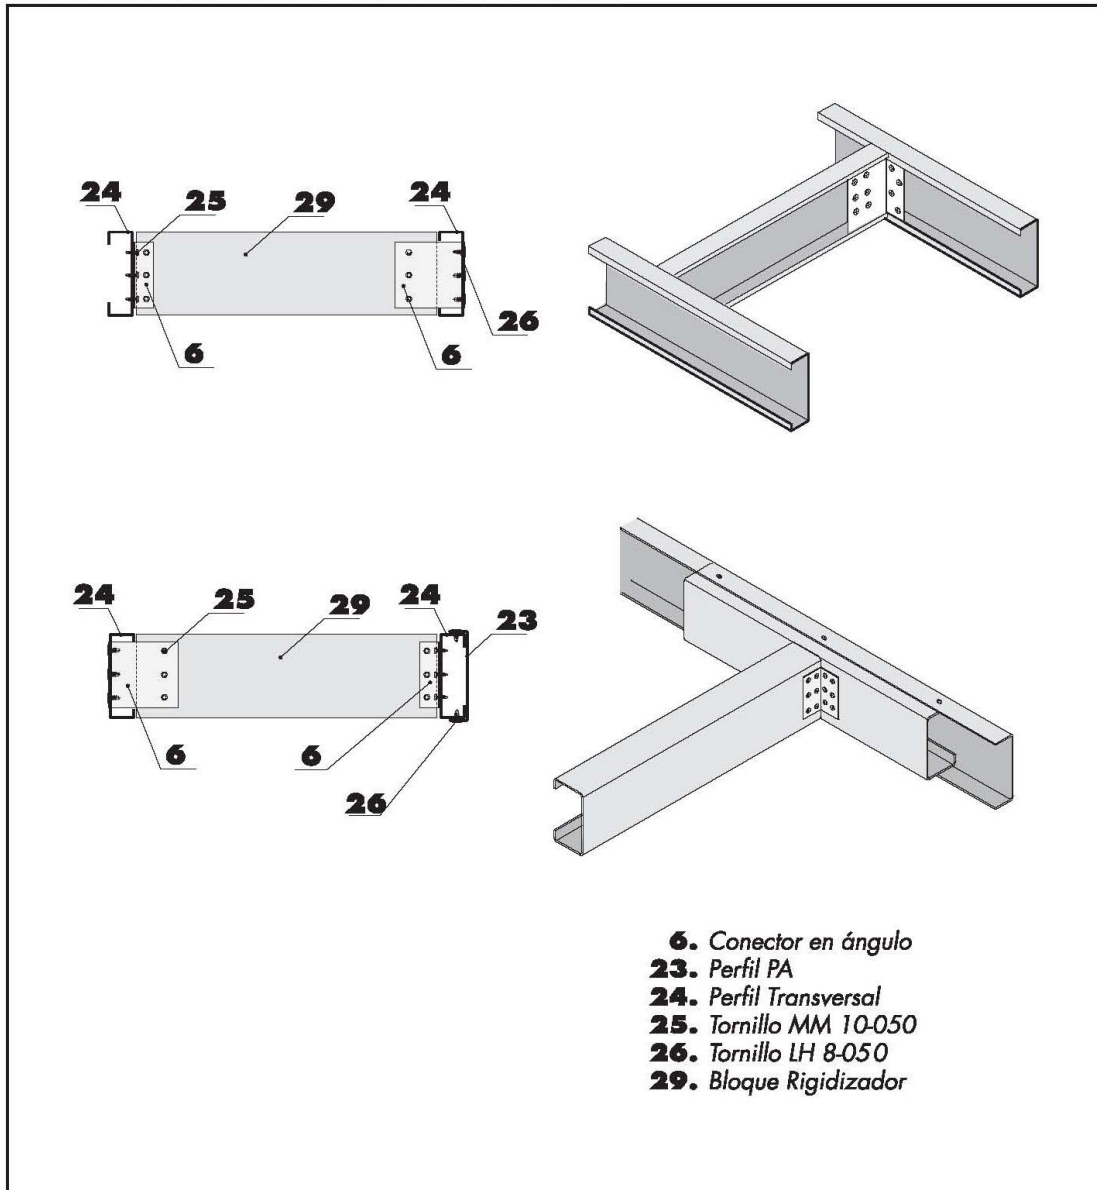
Detalle 3. Forjado. Rigidizadores entre perfiles de carga [87].
